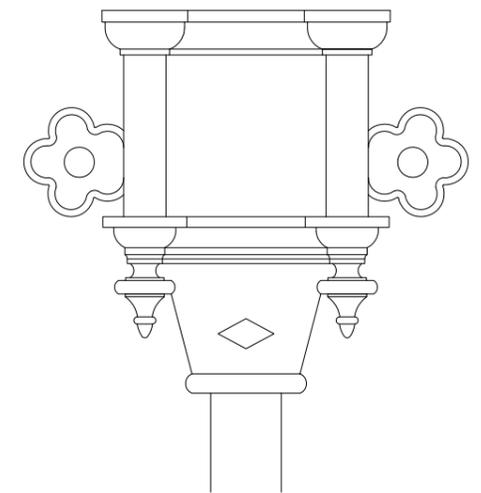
Detail eines Regenwassersammlers (Hopper head)
